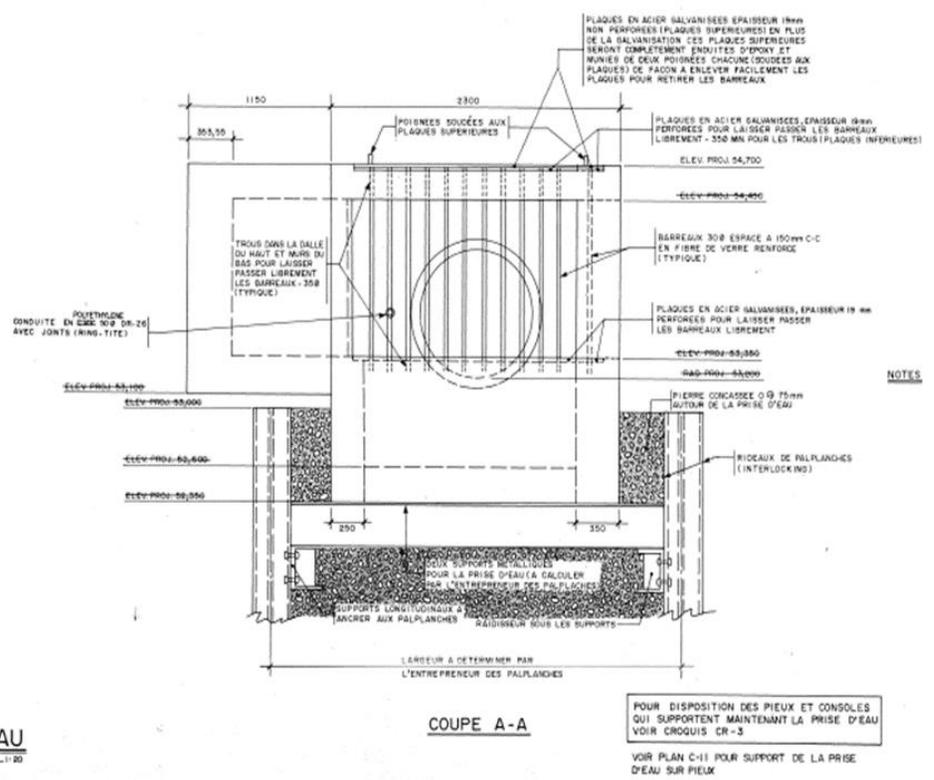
Profil hydraulique (vue en coupe) et détails de la prise d'eau de l'UPEP d'Aylmer.
